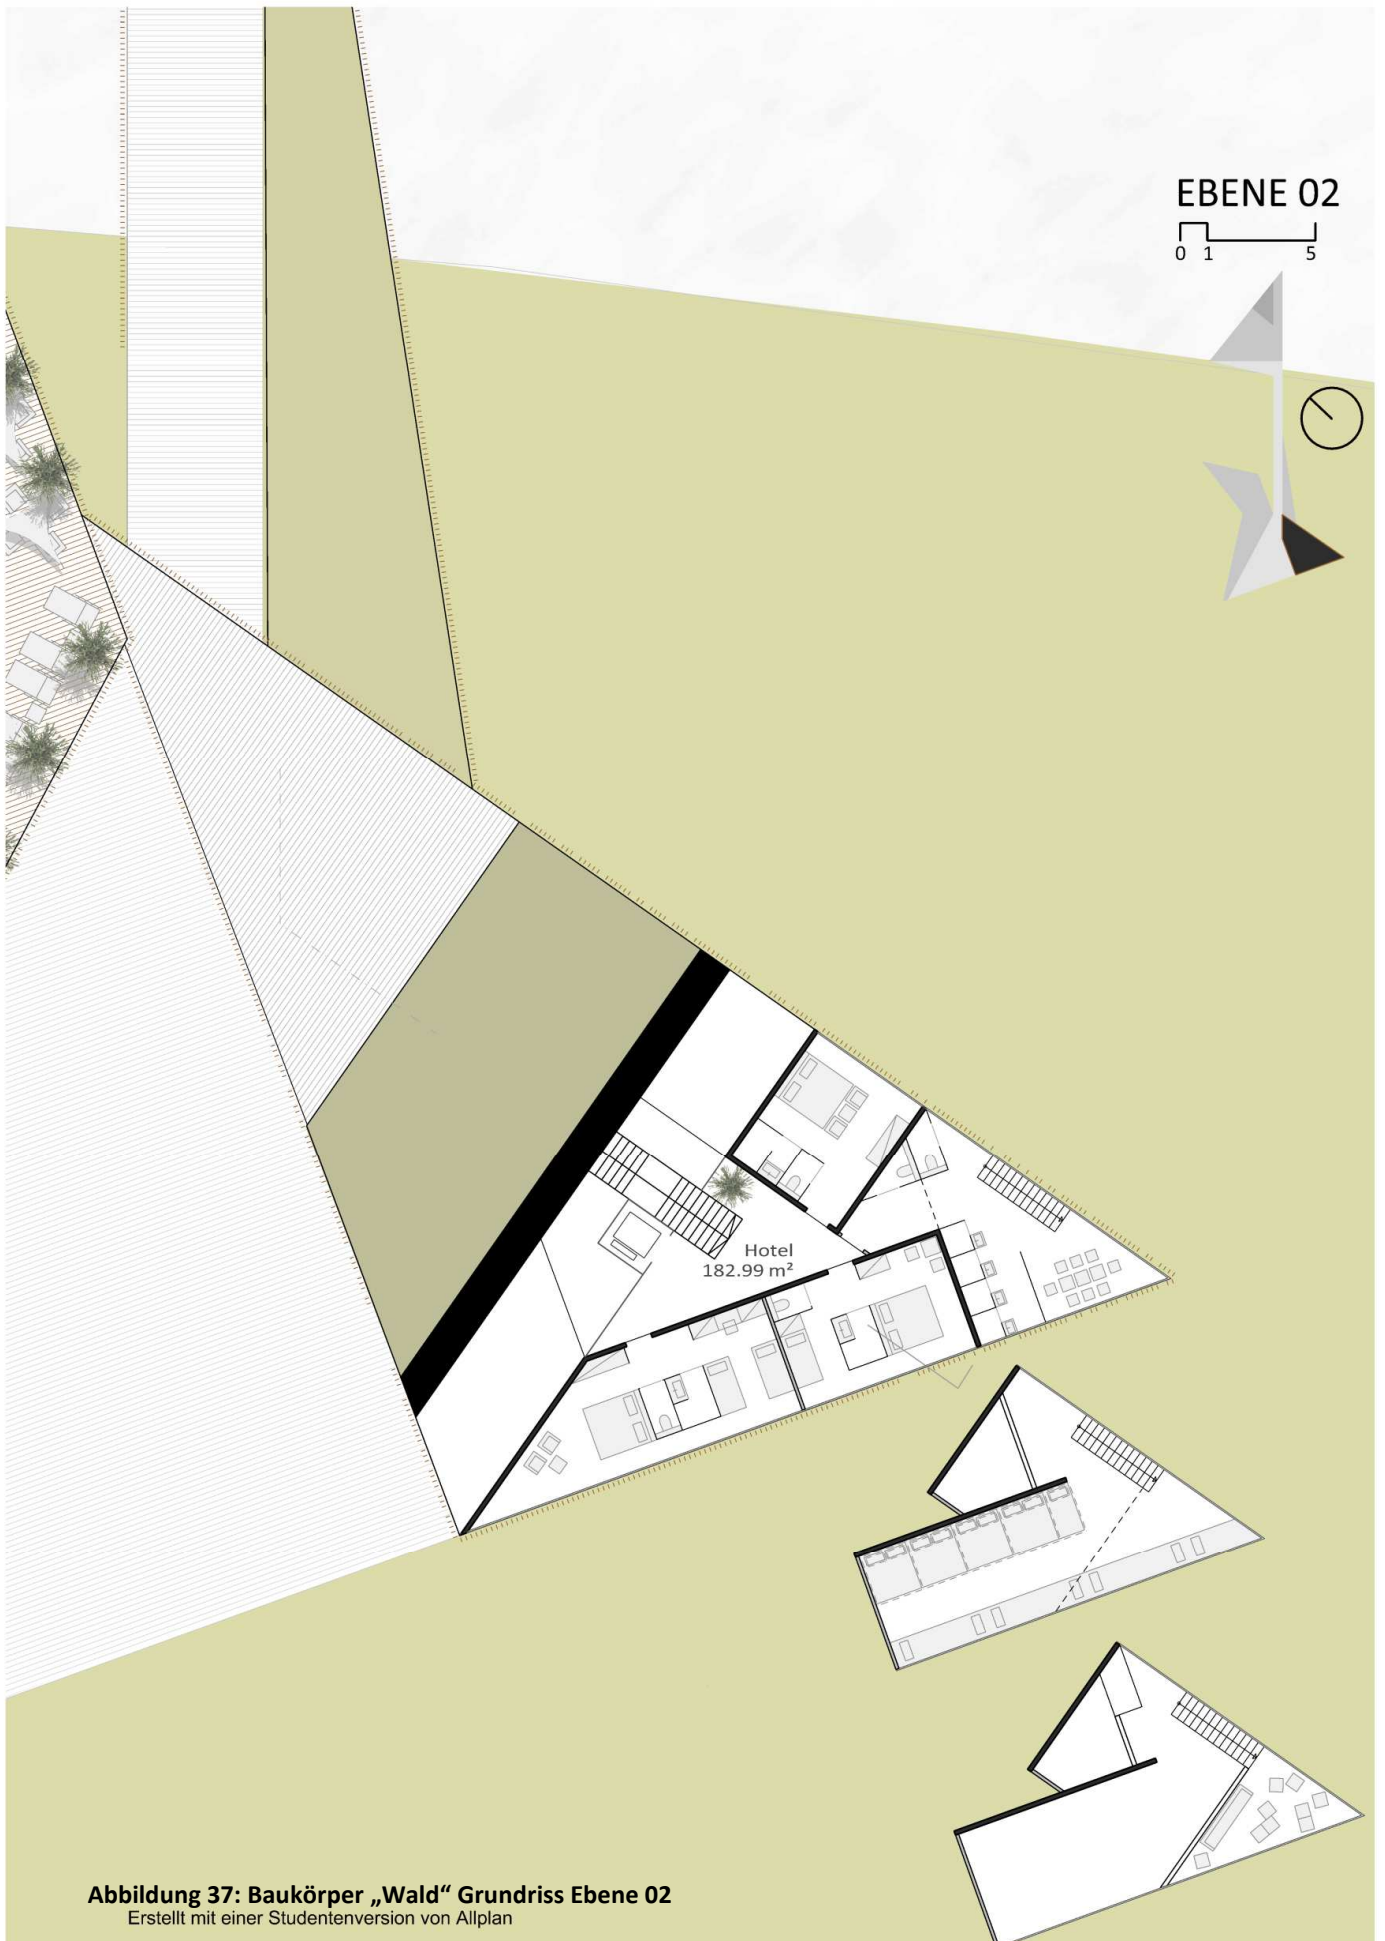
Baukörper „Wald“ Grundriss Ebene 02
